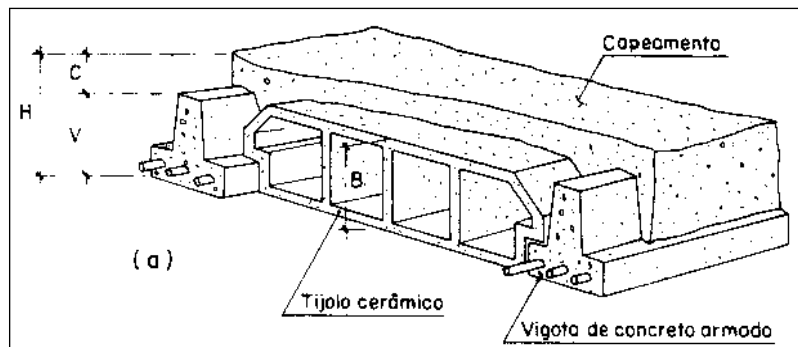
Laje pré-fabricada com nervuras em T invertido.
